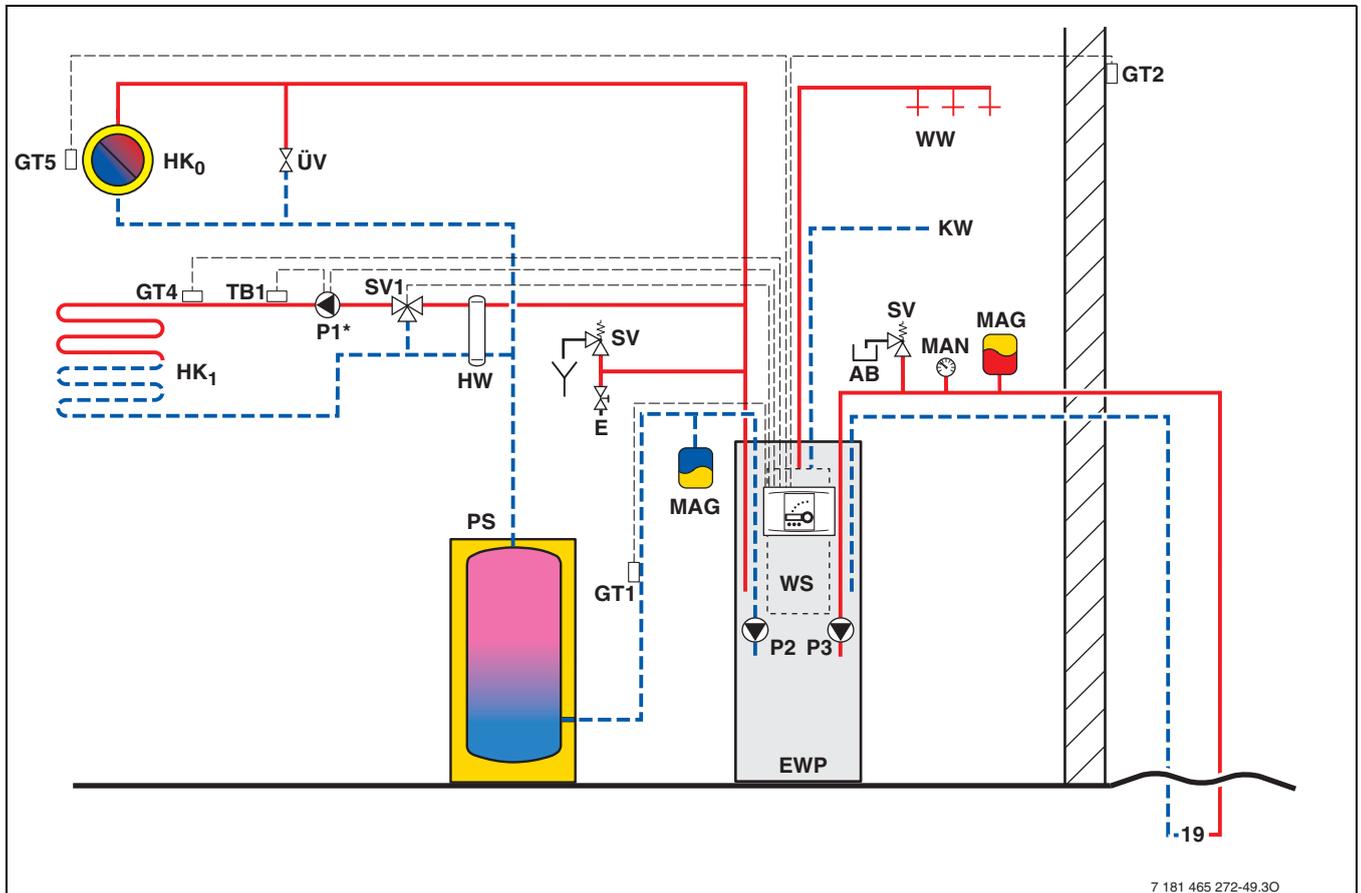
Heizungsanlage mit 1 Heizkreis und Warmwasserbereitung
